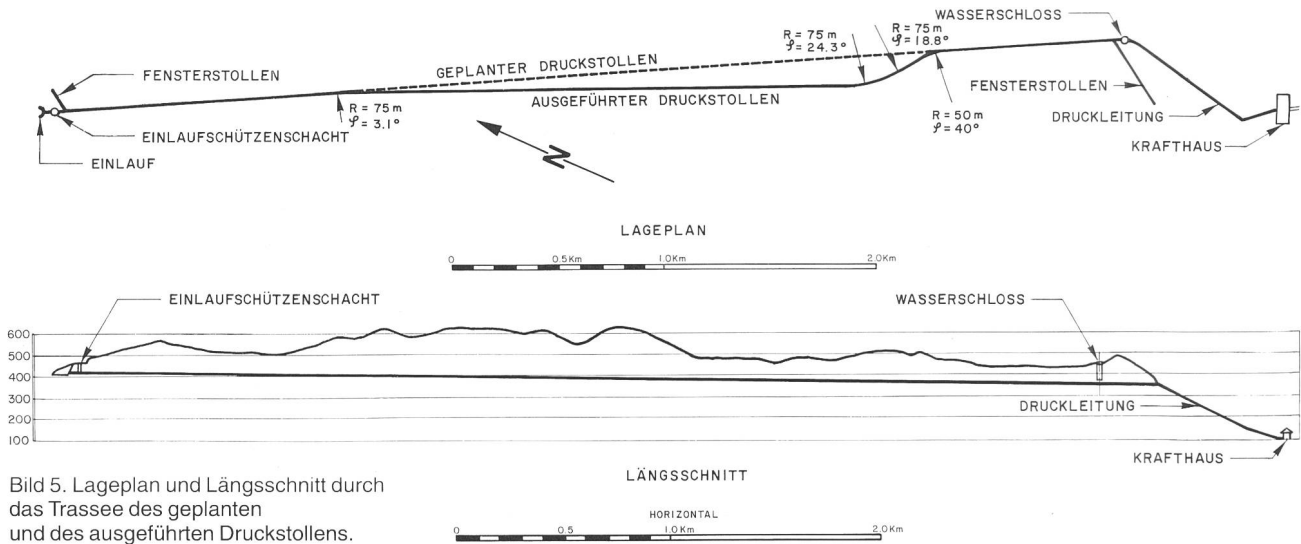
Lageplan und Längsschnitt durch das Trasse des geplanten und des ausgeführten Druckstollens.
